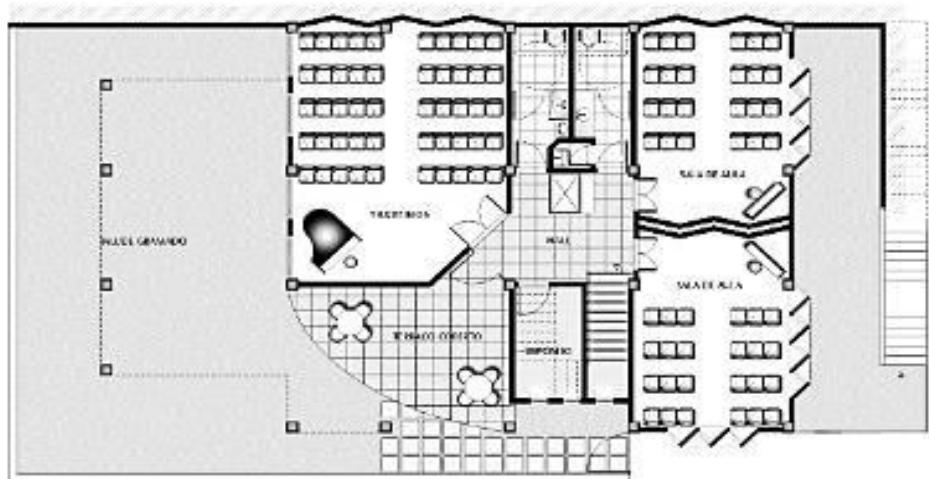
Pavimento térreo do Centro de Musicalização Infantil
